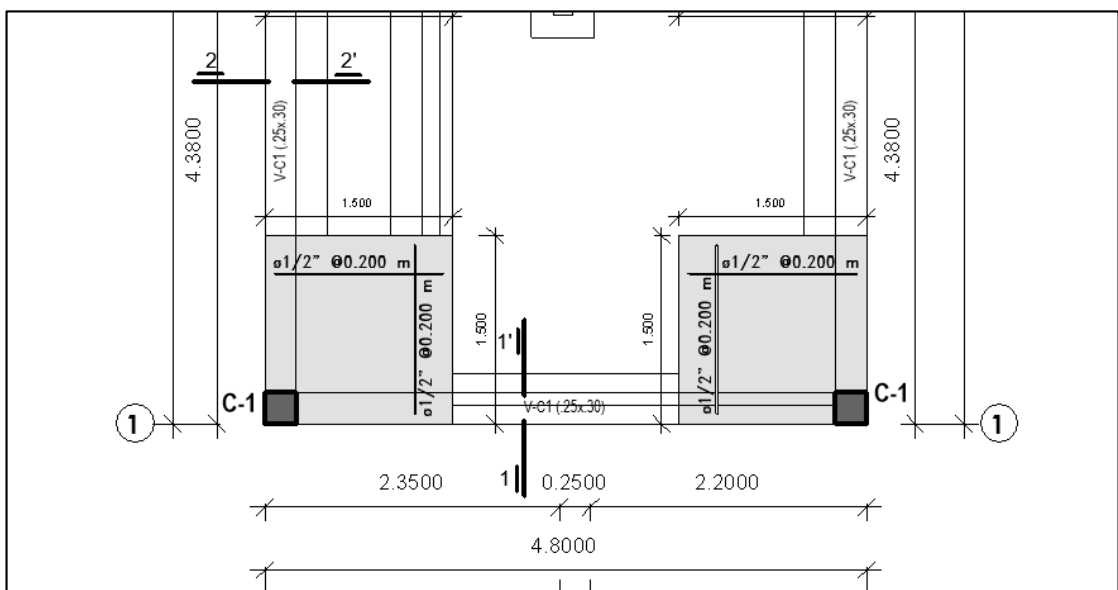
Sección de zapatas en plano de cimentación en BIM
